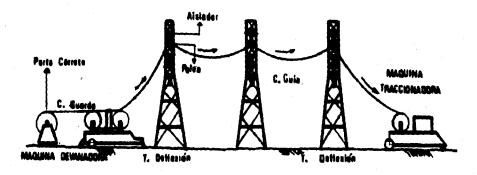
Figura VI.g. Disposición de las máquinas devanadora y traccionadora.
